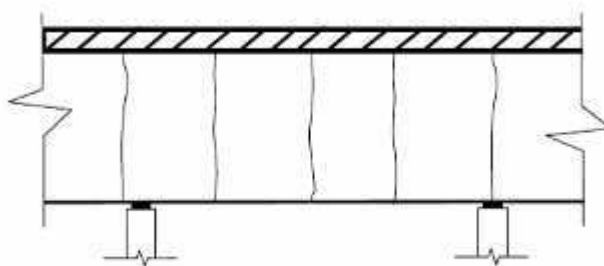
Fissuras de retração hidráulica, fonte DNER 1994
